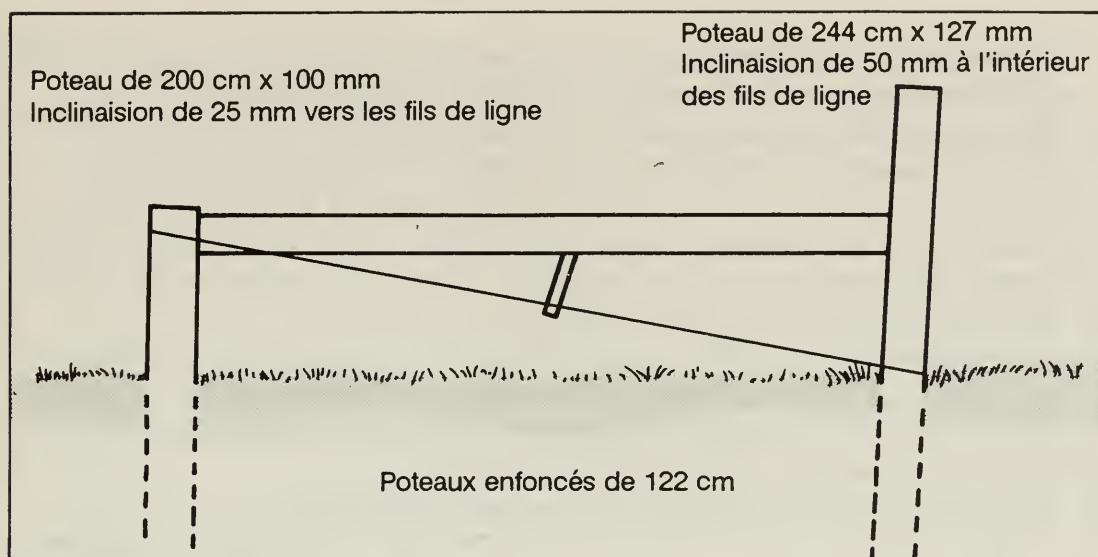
Construction d'un assemblage d'ancrage d'angle intermédiaire (fig. 30).
